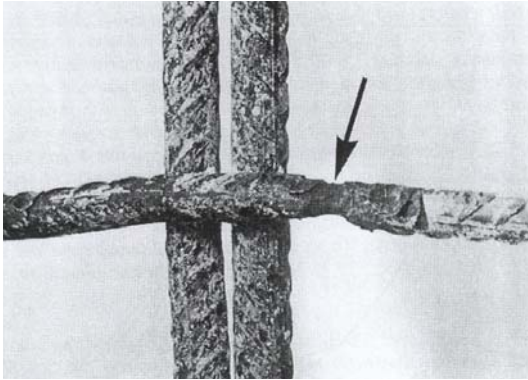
Korrosion der Bewehrung in einem Betonriss
